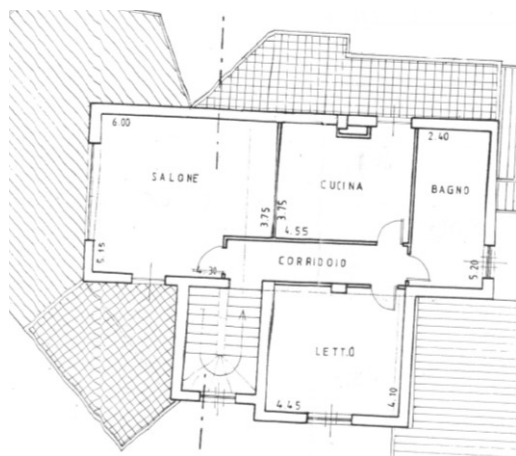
planimetria urbanistica del primo piano della villa secondo la C.E. in sanatoria n.82/1993
